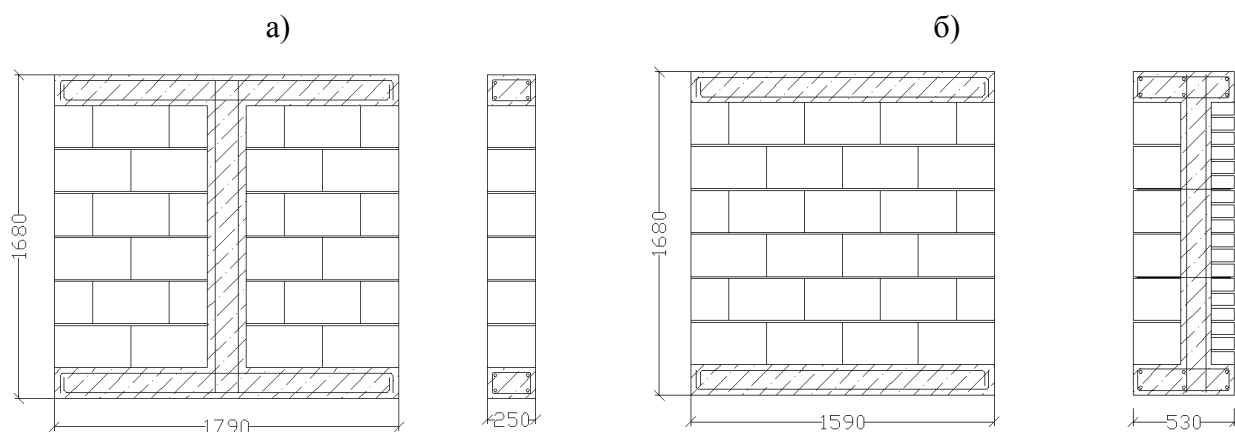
Фрагменты кладки стен для испытаний на перекос.
